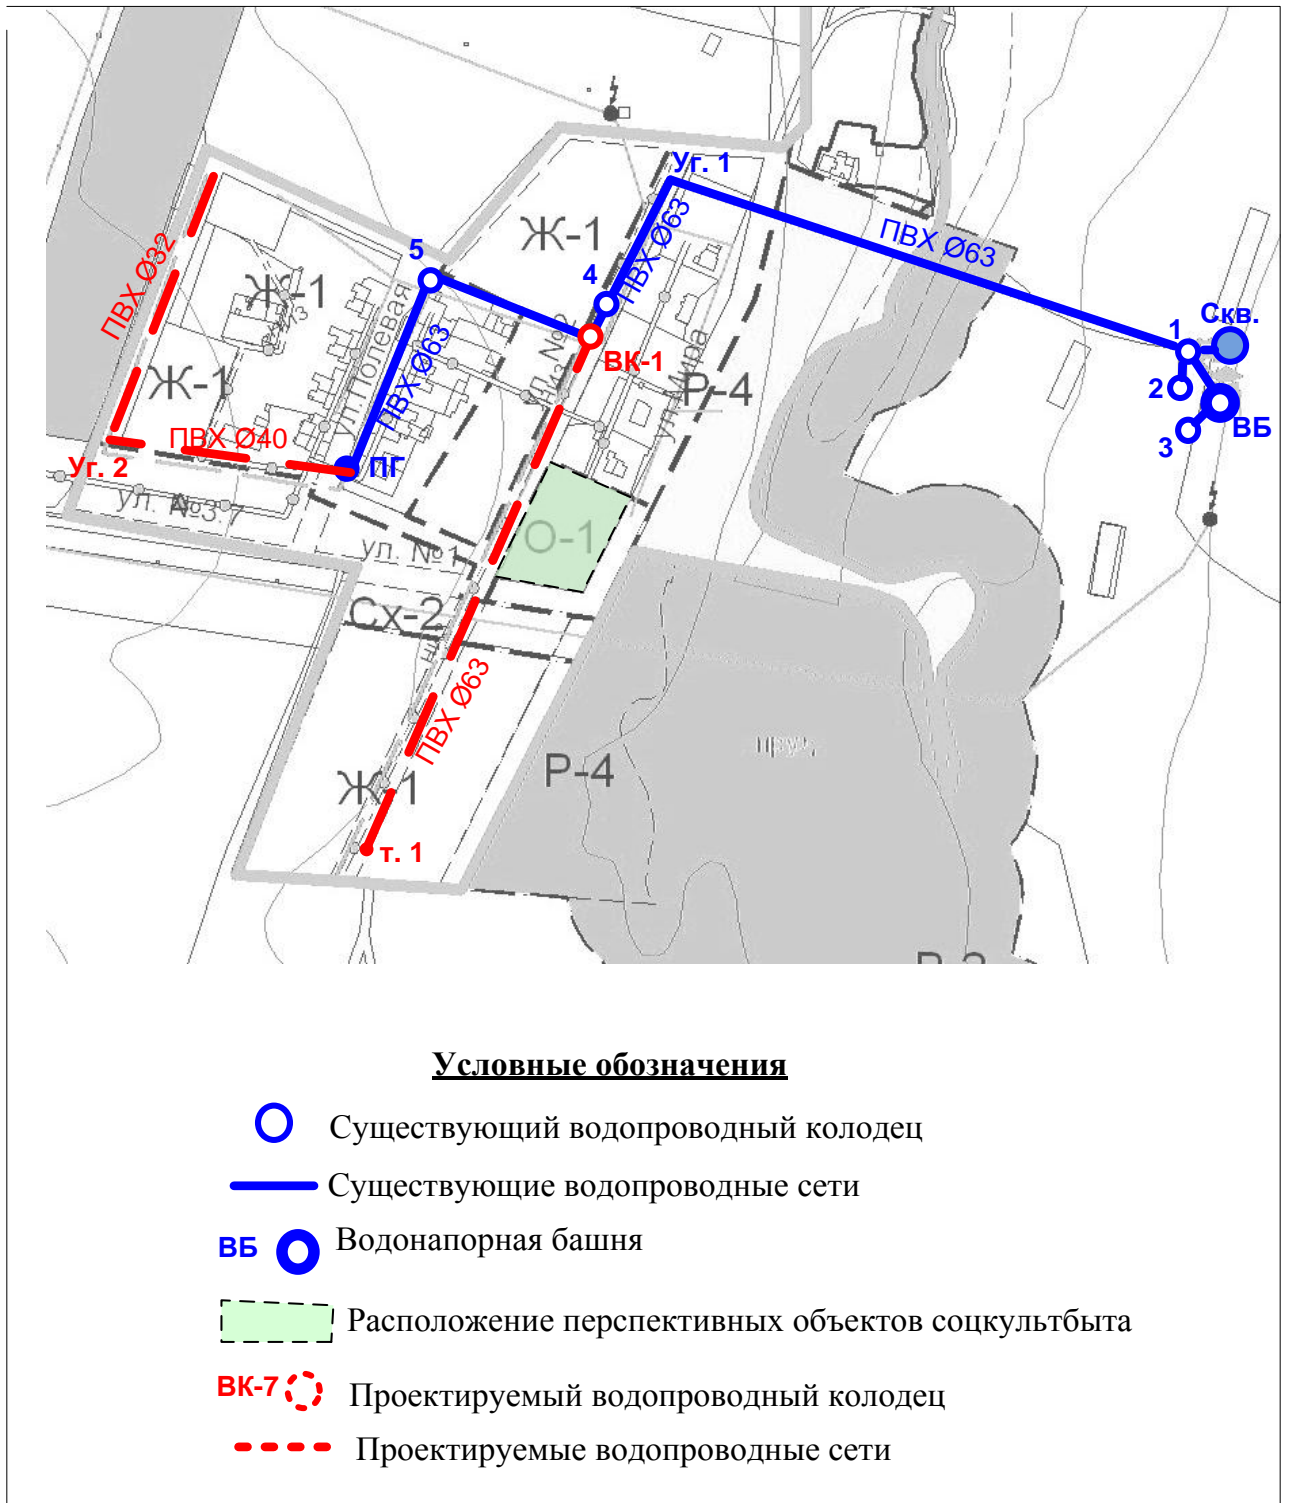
План развития водопроводных сетей поселка Каменный Дол до 2033 г.
